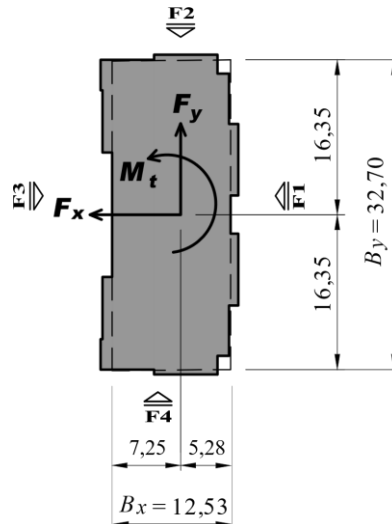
Planta baixa do pavimento tipo do Modelo I. Fonte: adaptado de LAC (2019).
